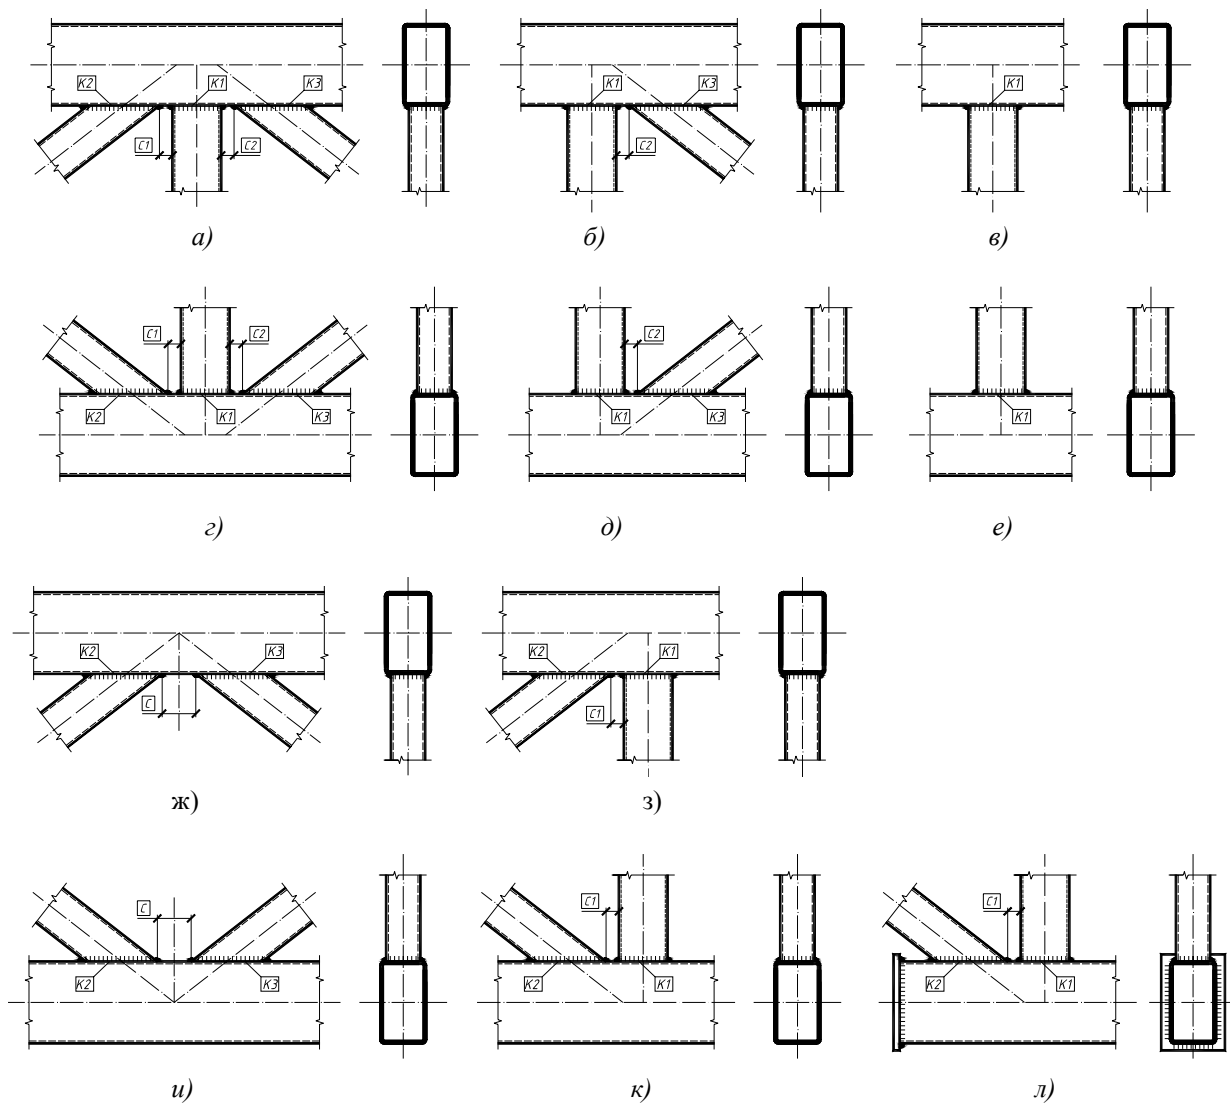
Рядовые узлы ферм из прямоугольных (квадратных) труб
